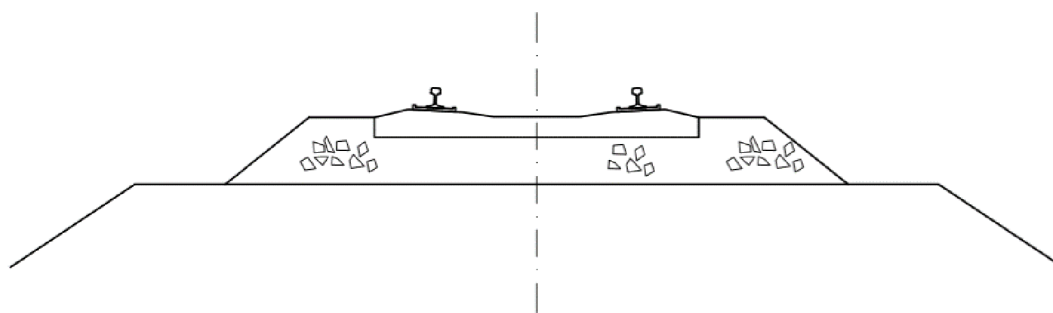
ZÁKLADNÍ ČÁSTI ŽELEZNIČNÍHO TĚLESA [1]
